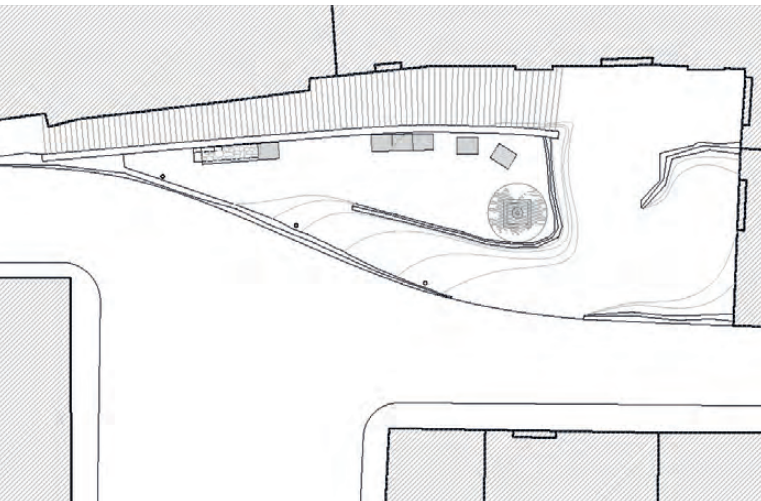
Planta de la propuesta (2000) / Figure 5. General plan of proposal (2000).
